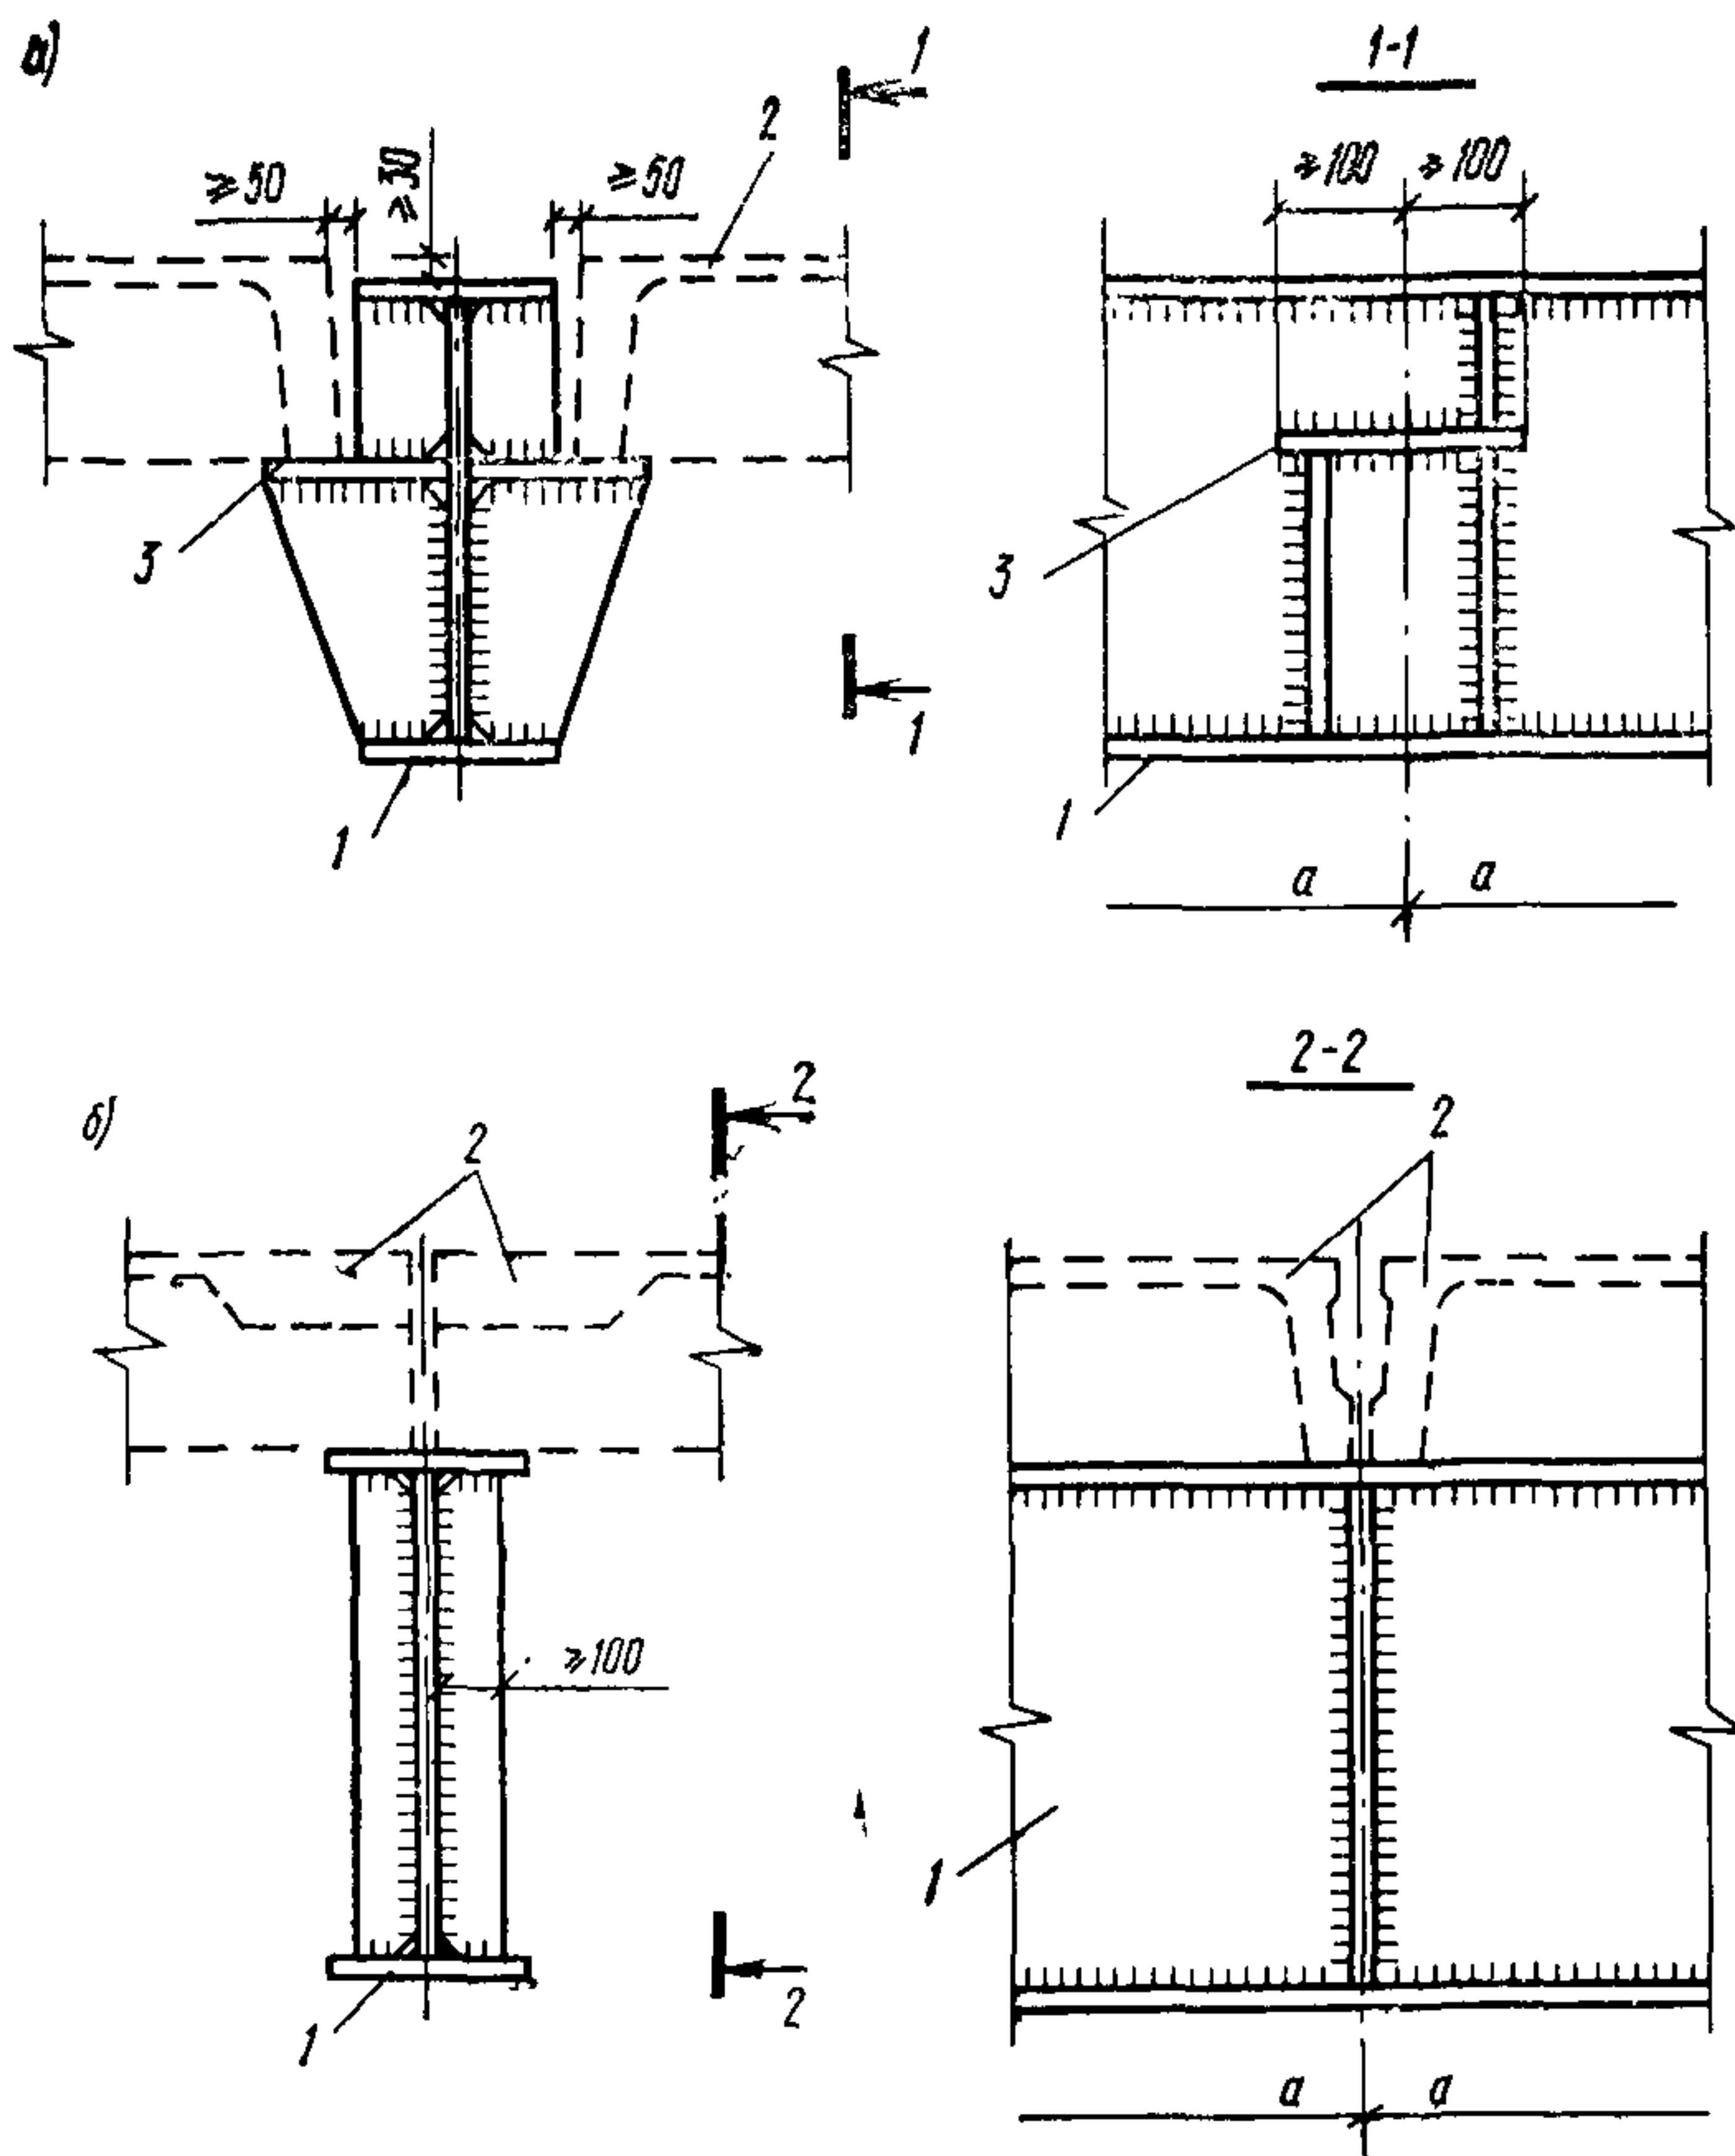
Планы перекрытий (покрытий) из сборных железобетонных плит с опиранием их на полки ригелей (а) и по верху ригелей (б)
